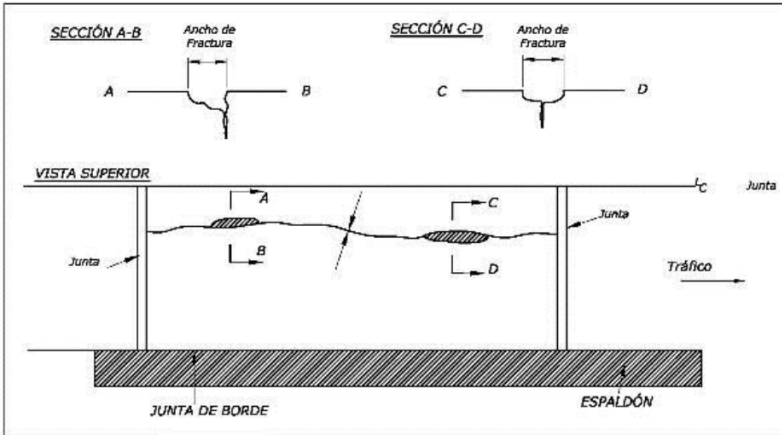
Esquema Grieta Longitudinal- Pavimento Rígido
